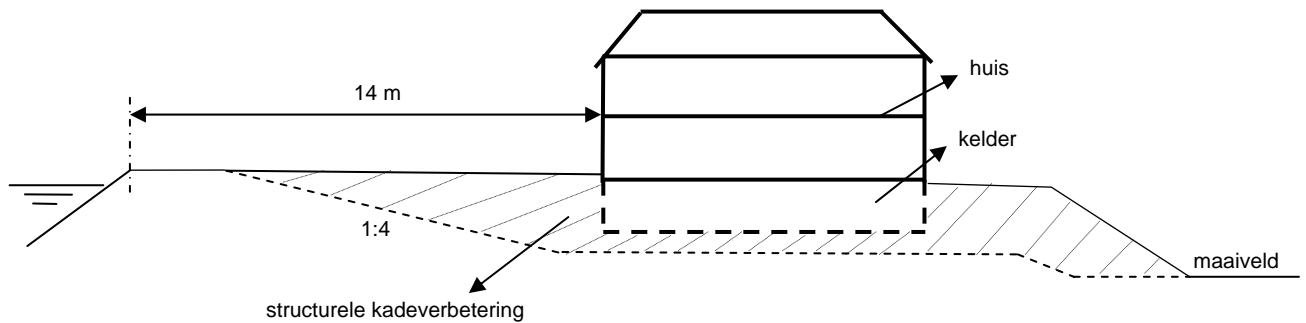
Bovenkant van werk op structurele kadeverbetering
